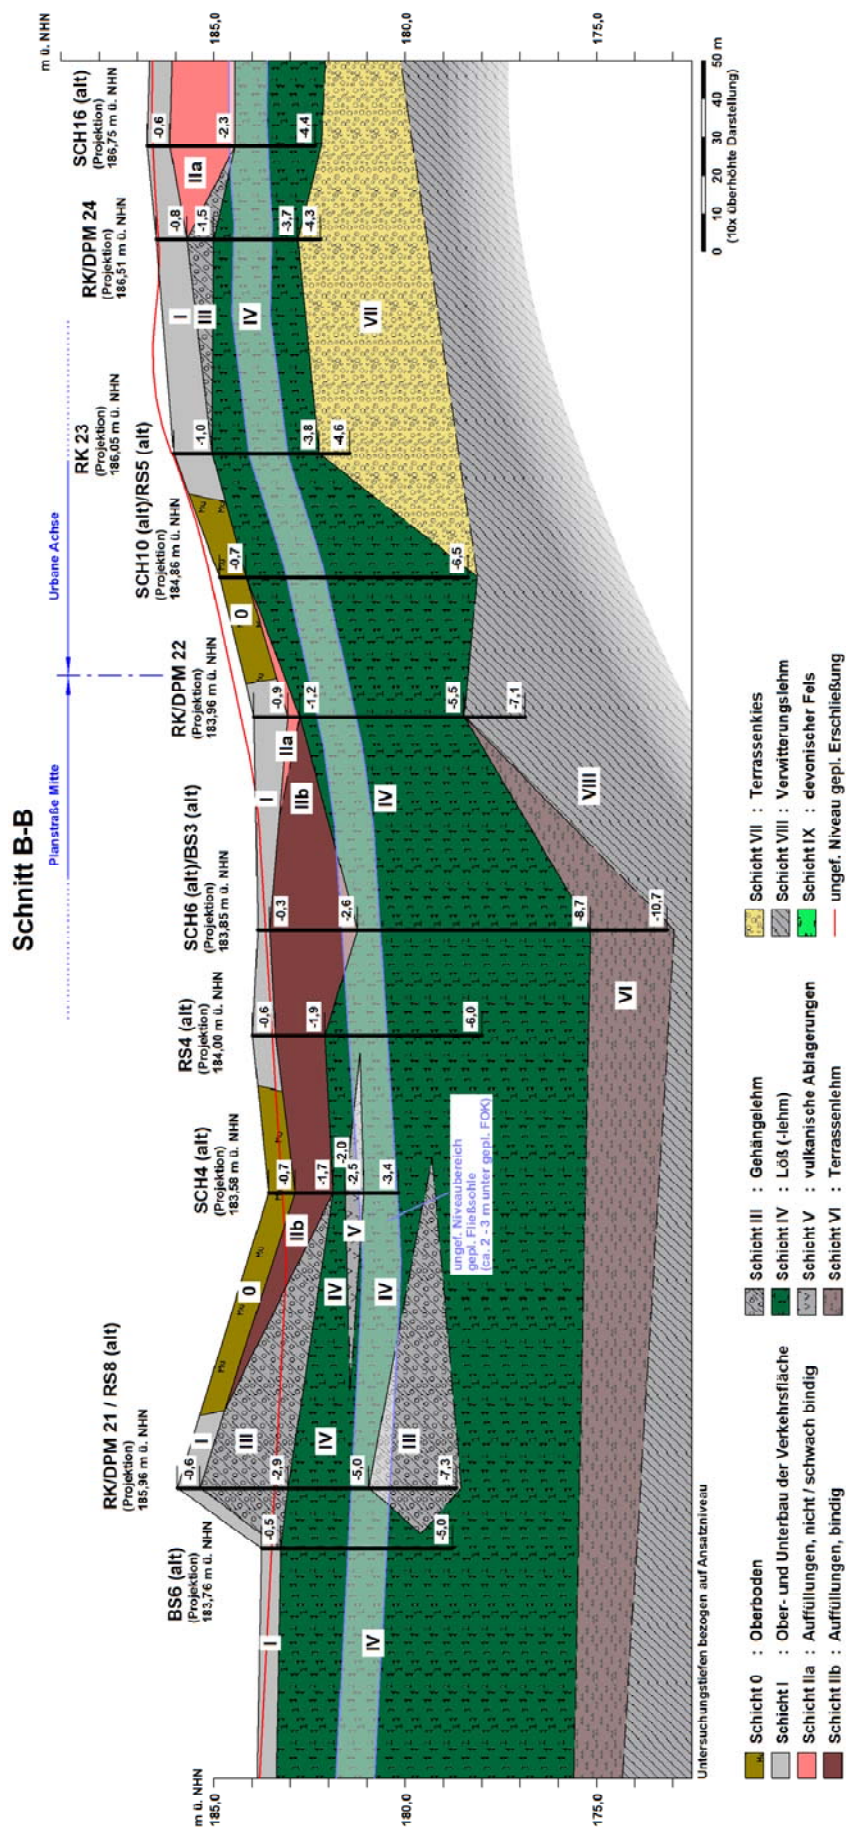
Baugrundmodell mit Schnitt B-B (Lage des Schnittes in Anlage 1)
